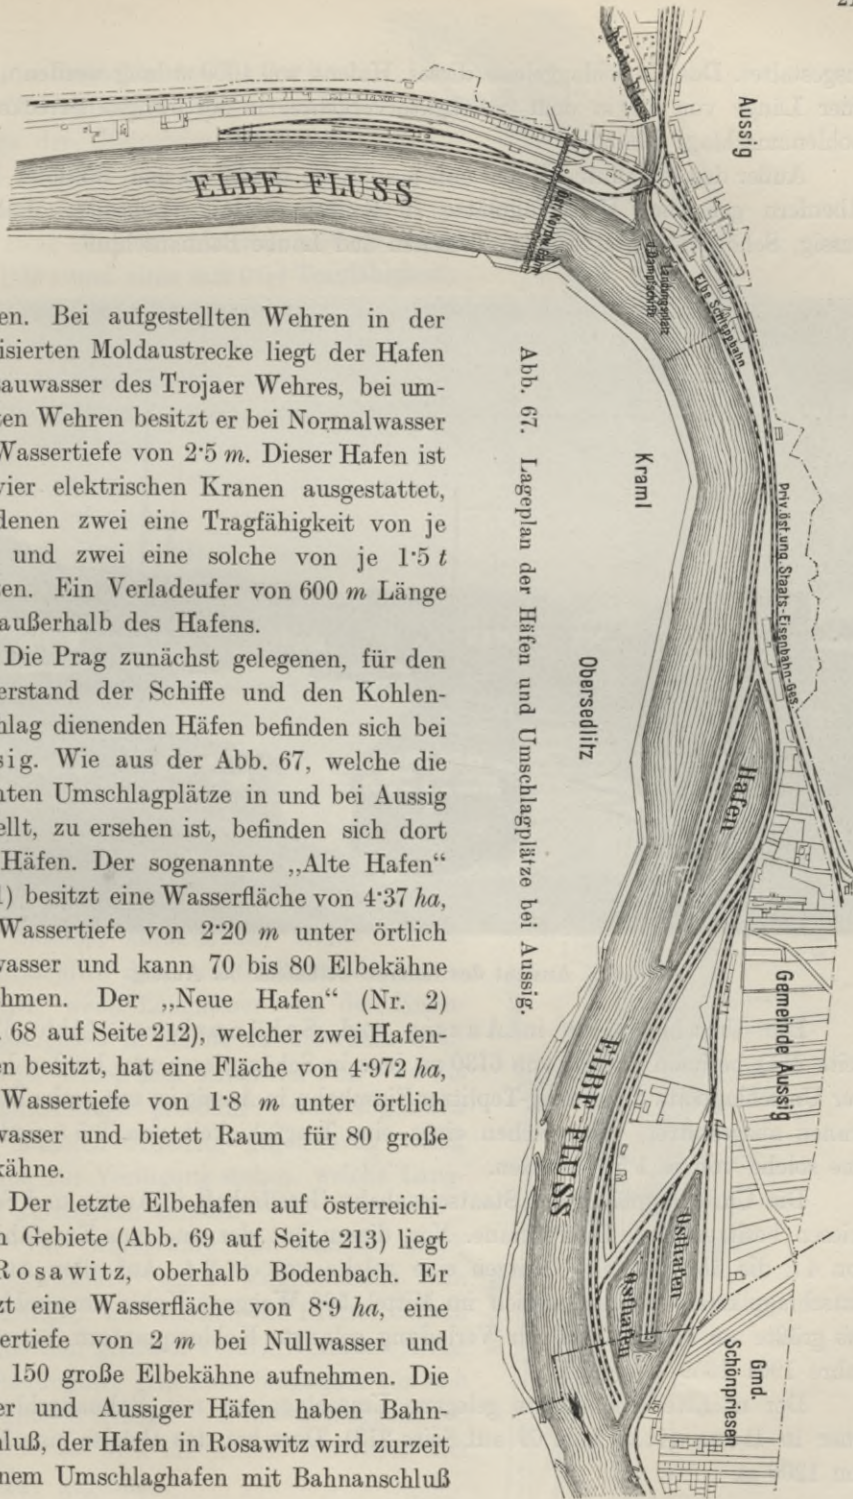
Lageplan der Häfen und Umschlagplätze bei Aussig.
